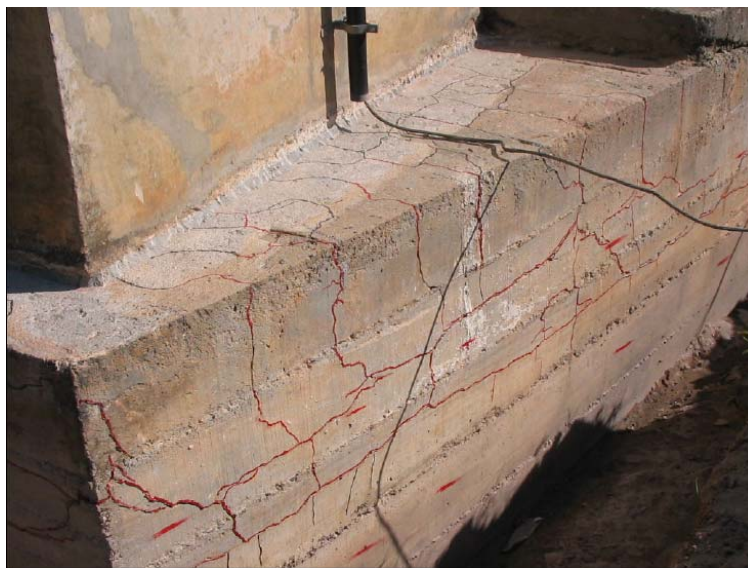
Vista de um bloco mostrando fissuras nas faces superior e lateral Fonte: ANDRADE, 2007
